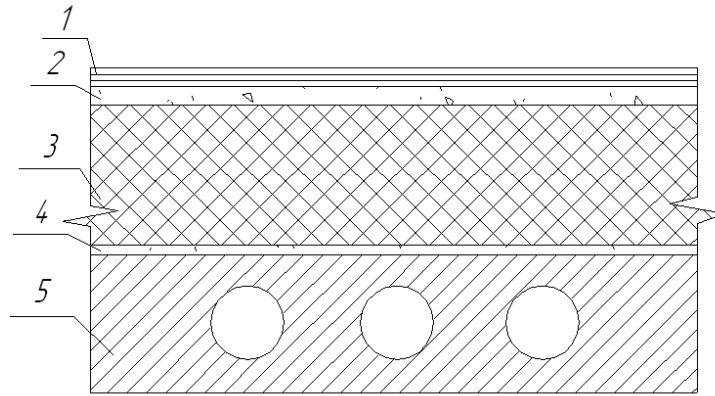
Схема до розрахунку тепловтрат через перекриття стелі
